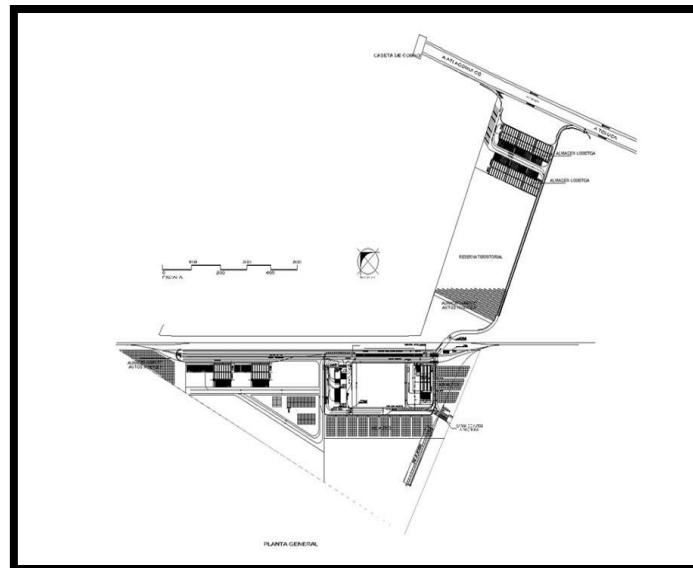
Plan Maestro Puerta México Terminal Intermodal
